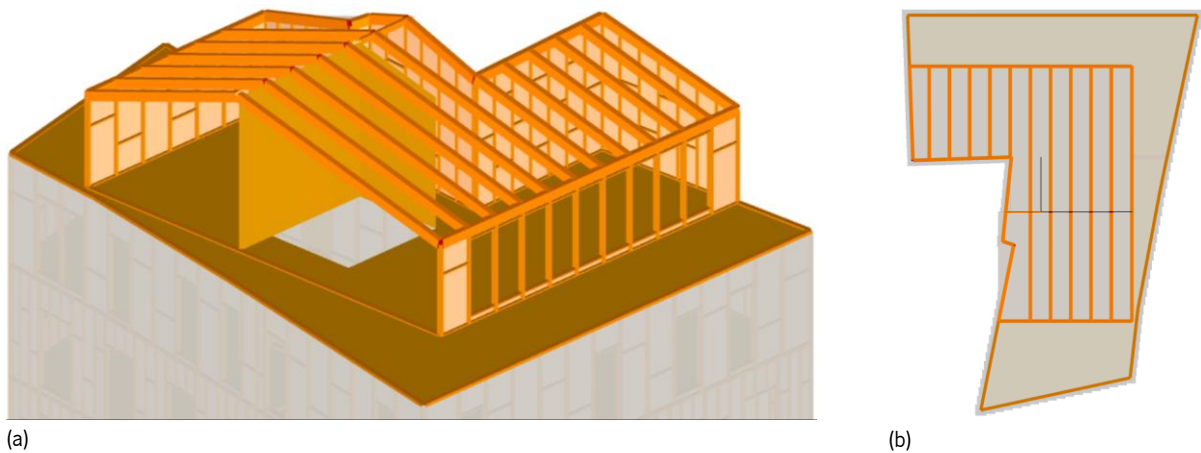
Parede de núcleo suportando as vigas de cobertura. (a) 3D; (b) Planta da cobertura
